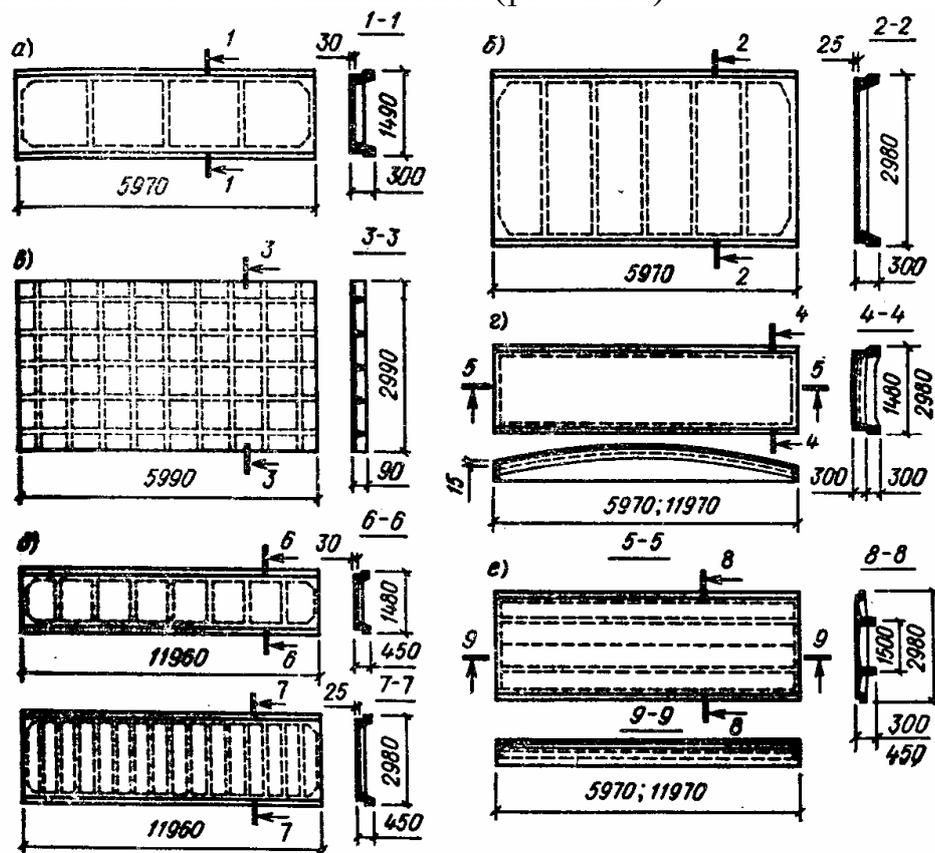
Крупноразмерные железобетонные панели покрытий:
